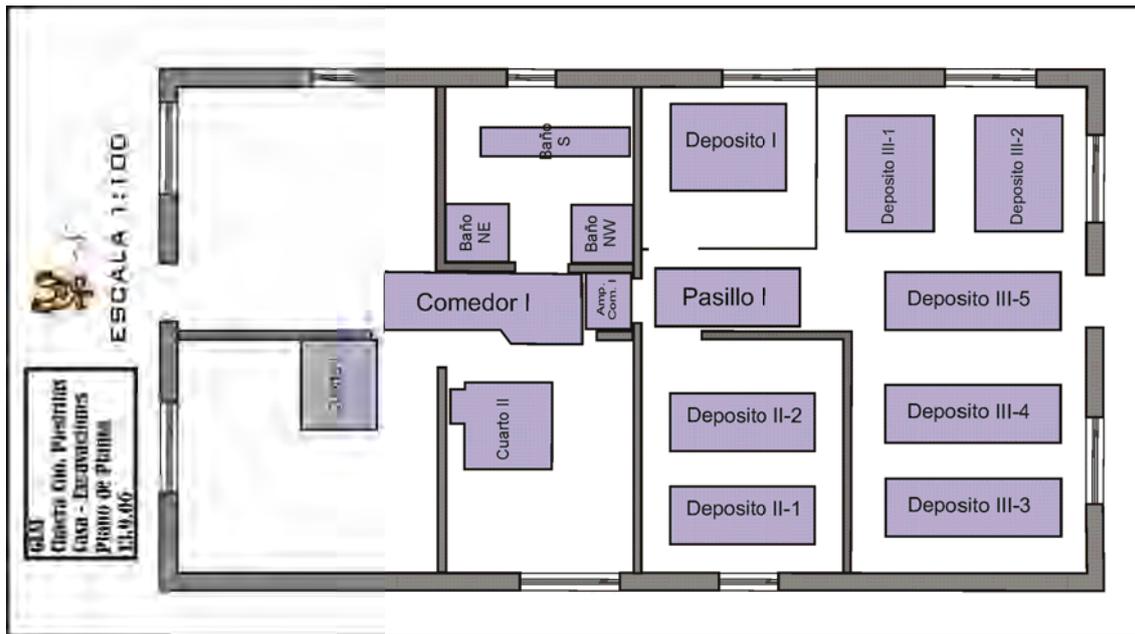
Plano de Planta de la Casa con las intervenciones arqueológicas efectuadas.
